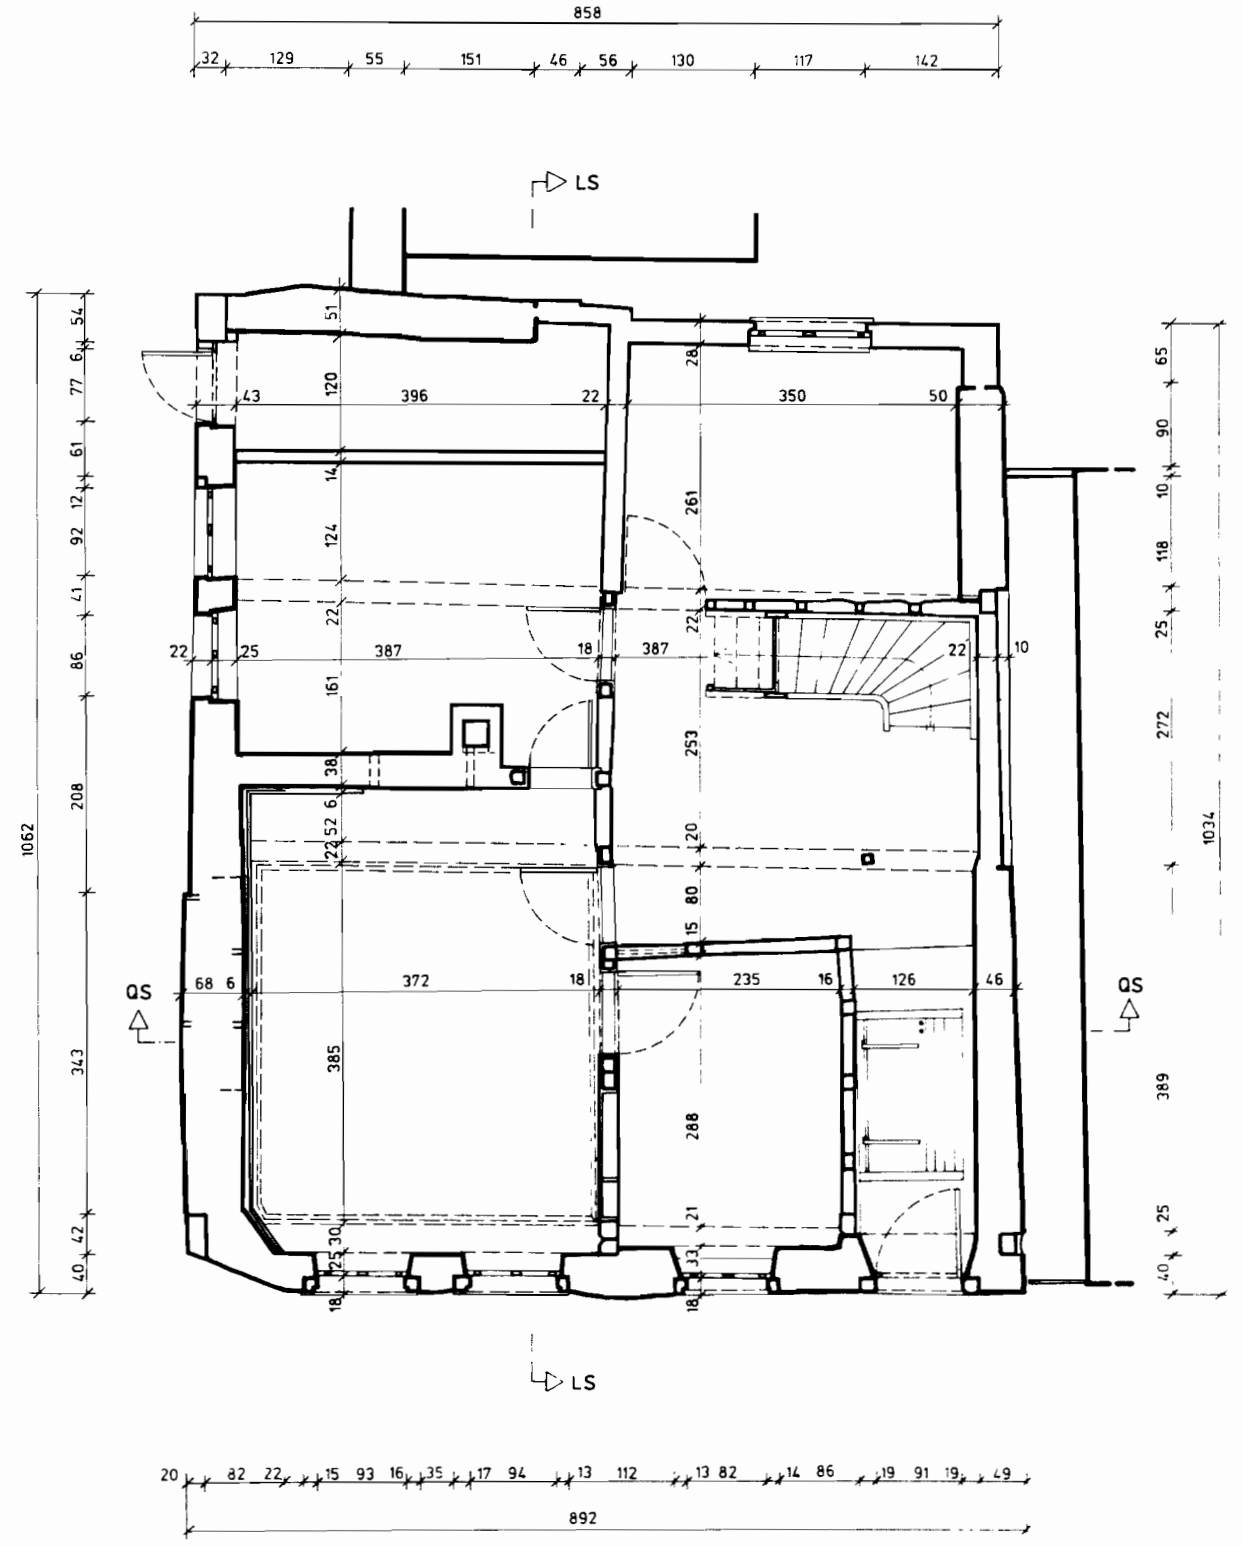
Genauigkeitsstufe III. Marktgröningen, Marktbrunnengässle 4, Grundriss EG. Handaufmaß im Maßstab 1:50, verkleinert auf Maßstab 1:75, Reinzeichnung mit Maßketten.
